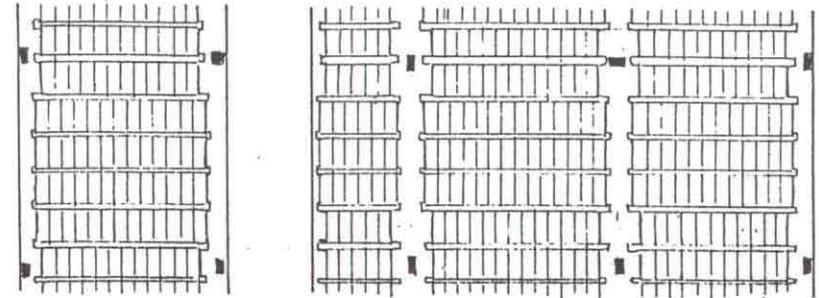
Tipos de tramo: aislados, voladizo, interior y extremo
